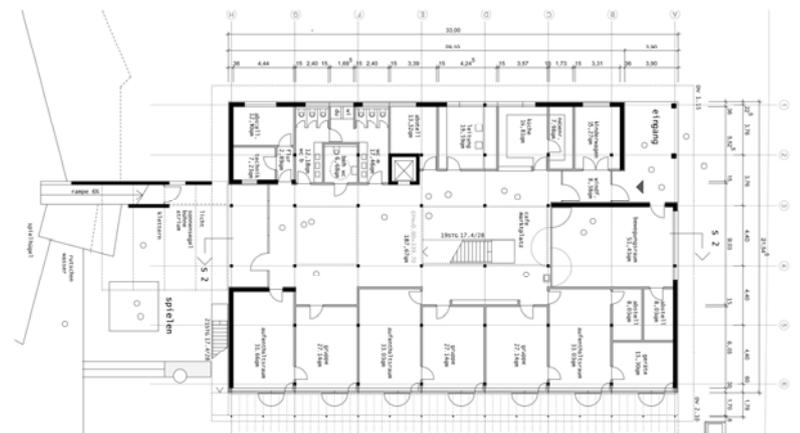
Grundrisse und Schnitt des untersuchten Schulgebäudes.
